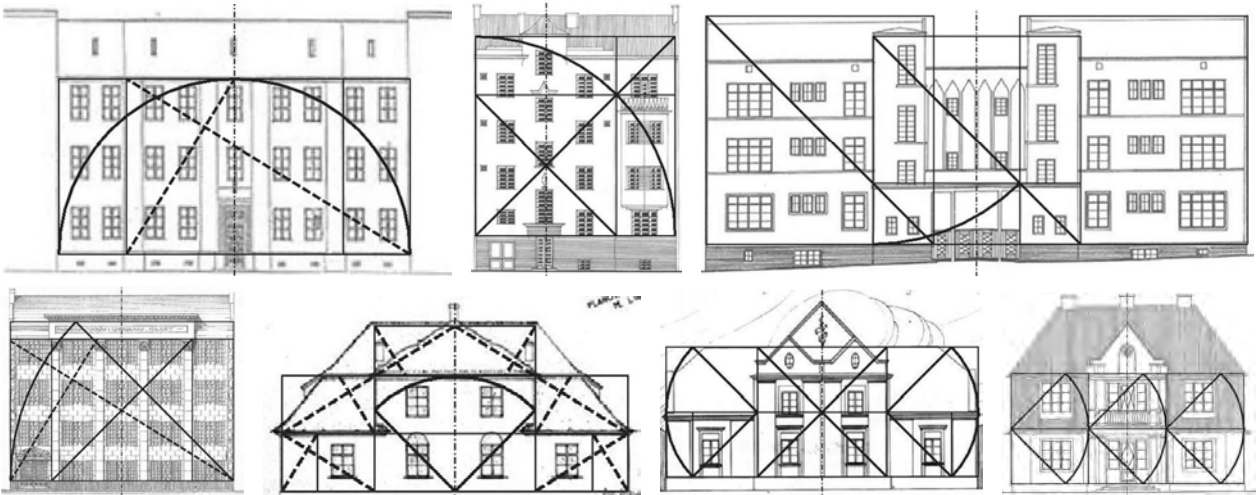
Схеми пропорціювання фасадів у стилі арт-деко
